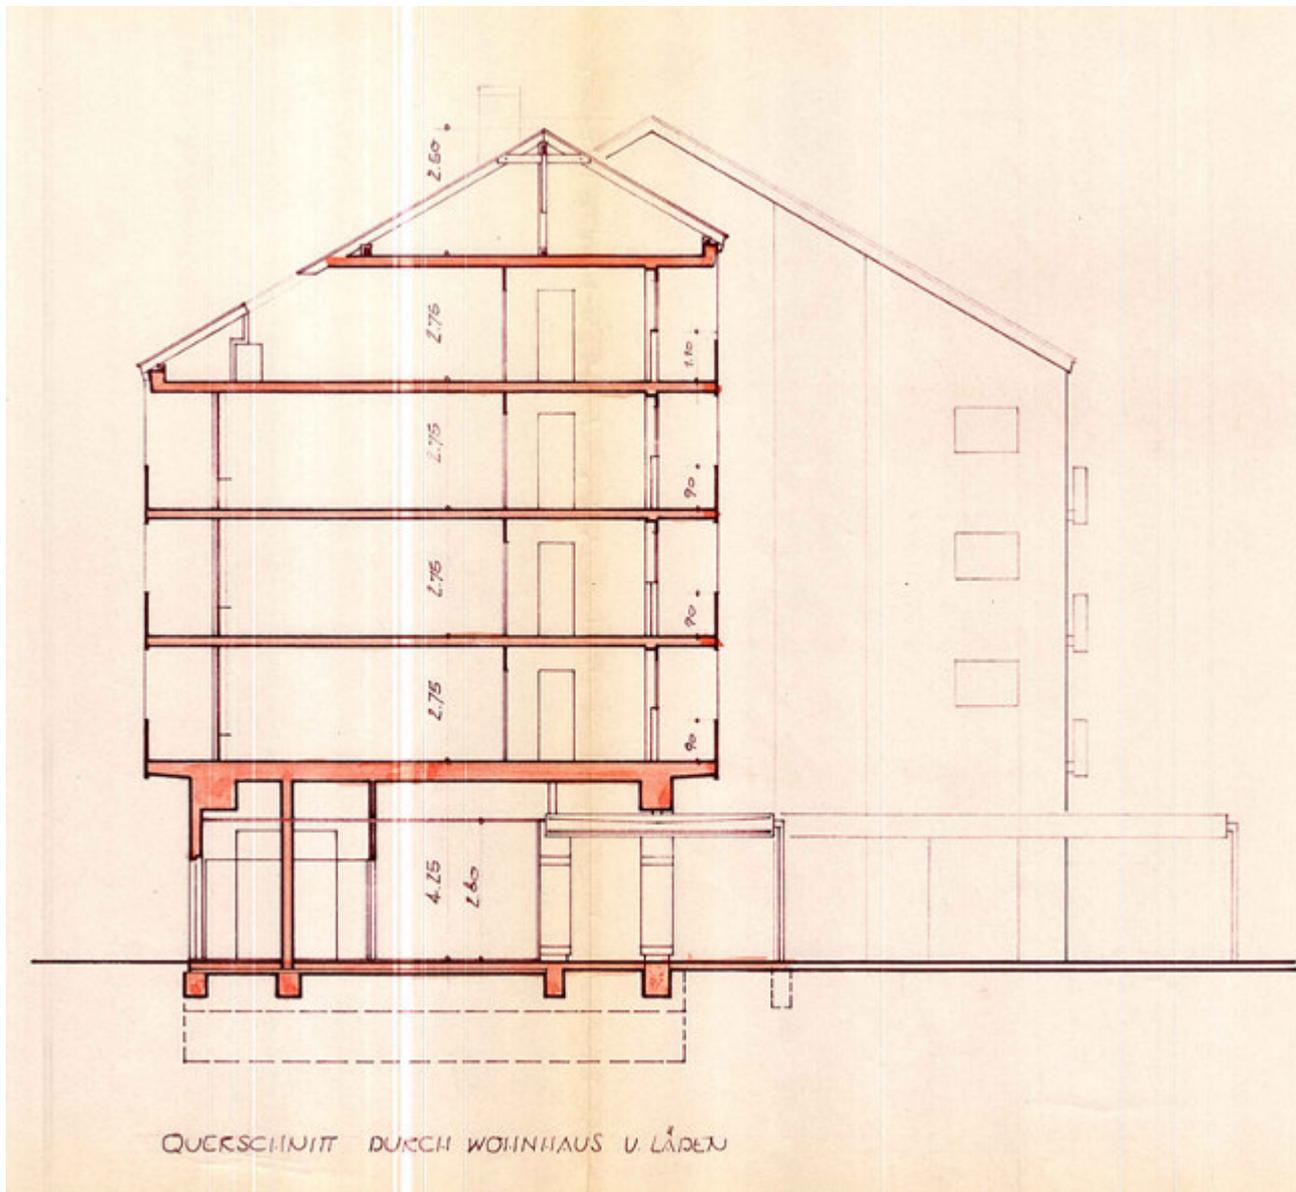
Querschnitt durch Wohnhaus und Läden; Quelle: Bauakte
